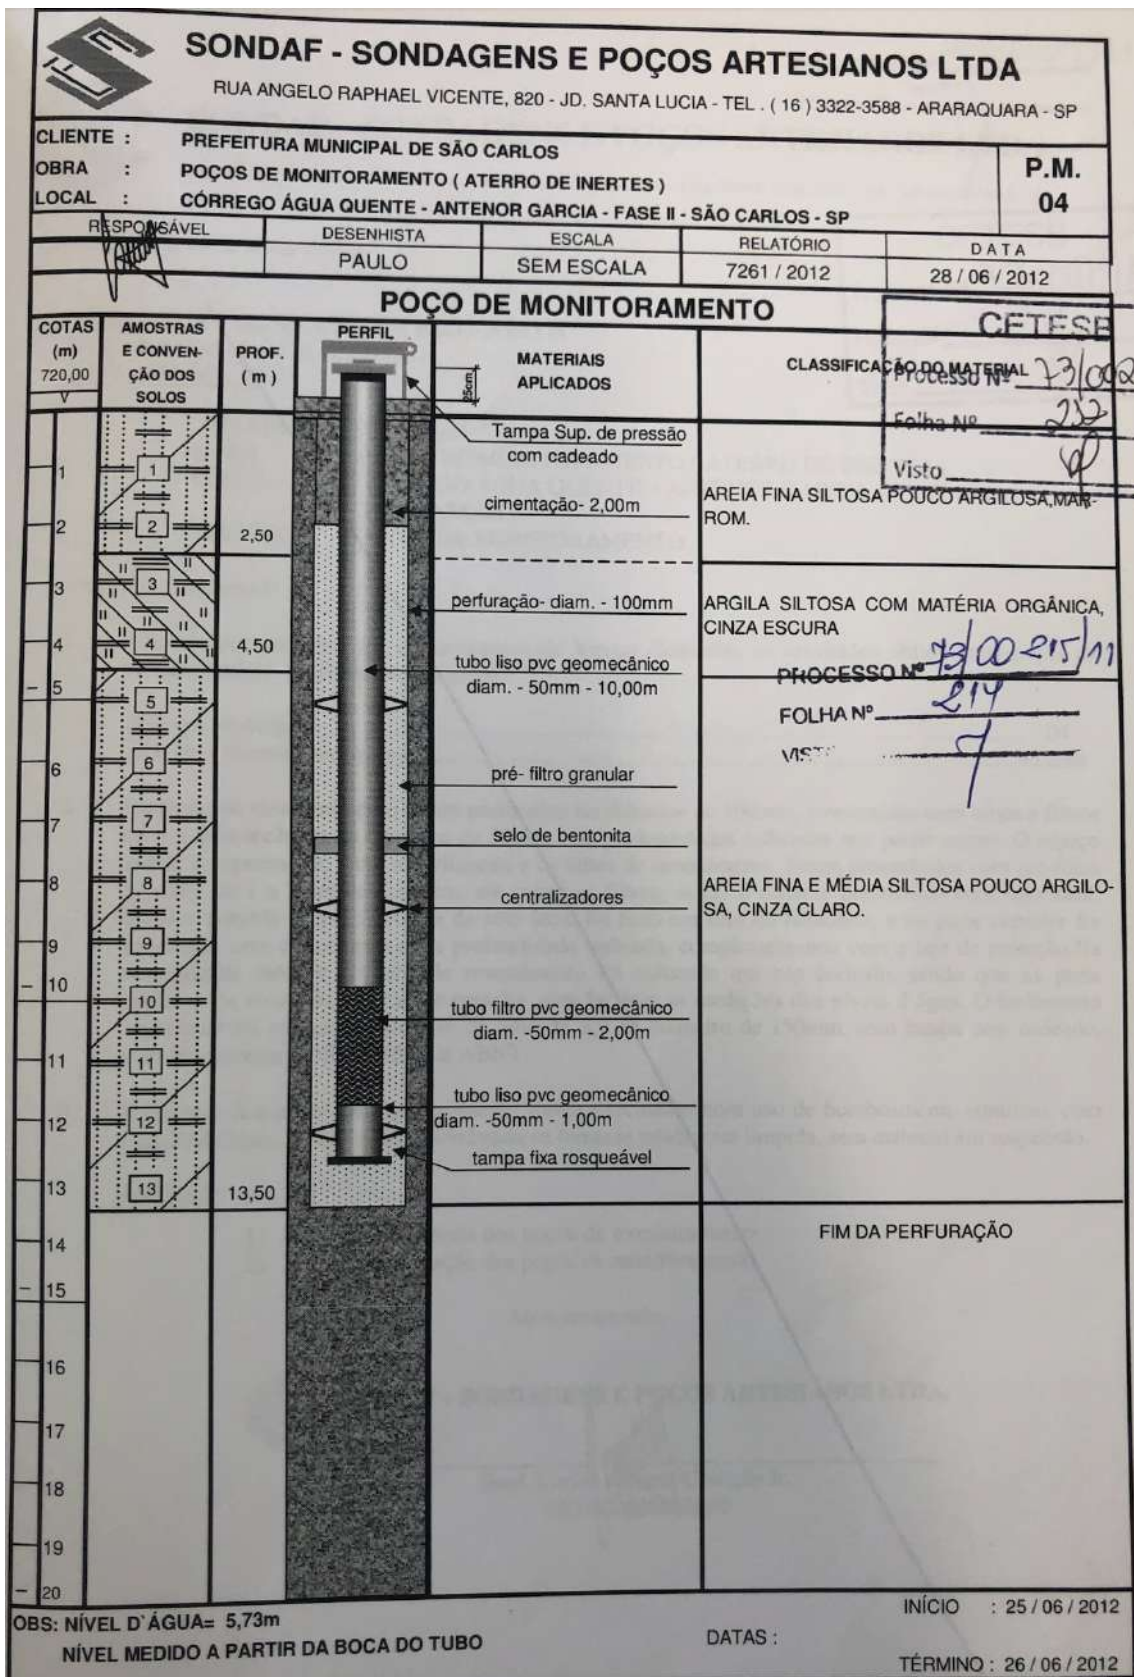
Figura LVI: Perfil construtivo do poço de monitorização PM-04
